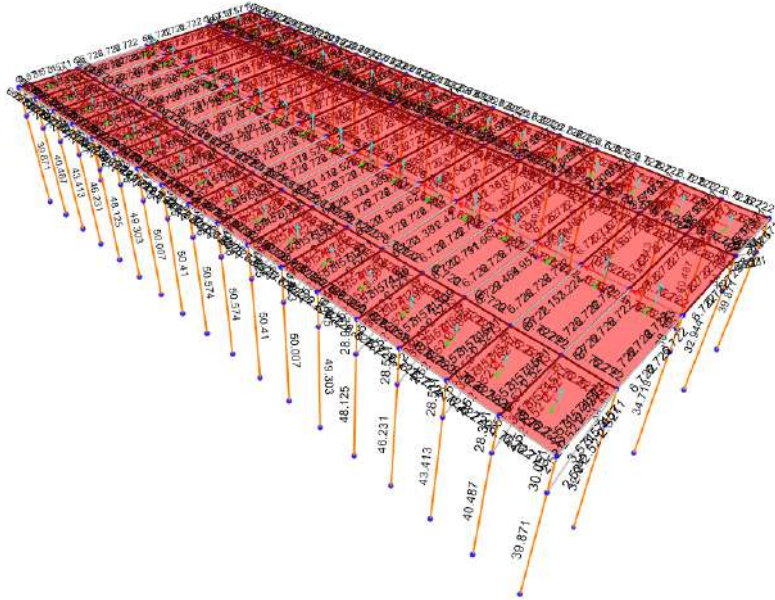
Sipërfaqja e armimit në strukturën betonarme
